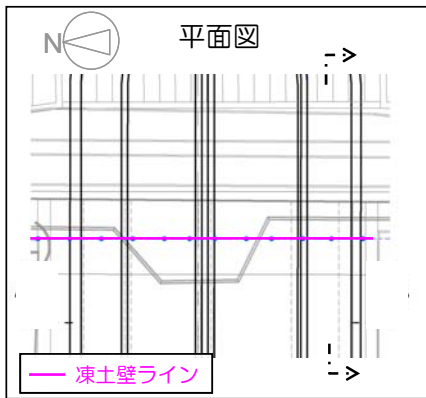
【5-1】1号機電気ケーブルダクト 施工方法（貫通施工）
